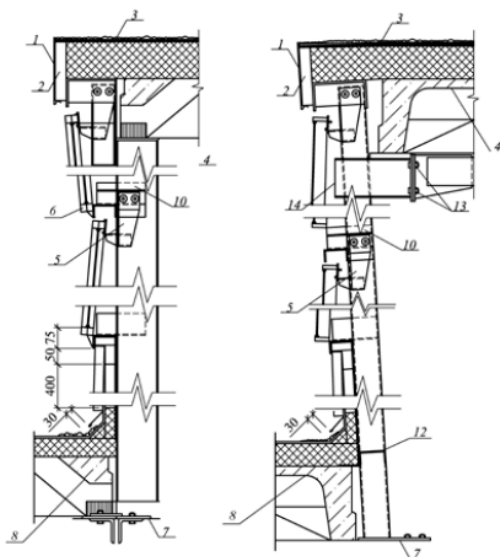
Розріз ліхтаря по торцевій (зліва) та поздовжній (справа) стіні: 1- фартух з оцинкованої сталі, 2 – борт; 3 – рулонна поківля; 4 – зб плита покриття; 5 – кронштейн віконний; 6 – рама; 7 – верх кроквяної ферми; 8 – зб плита; 9, 11, 14 – гнутий швелер; 10, 12 – гнутий кутик; 13 – болти
